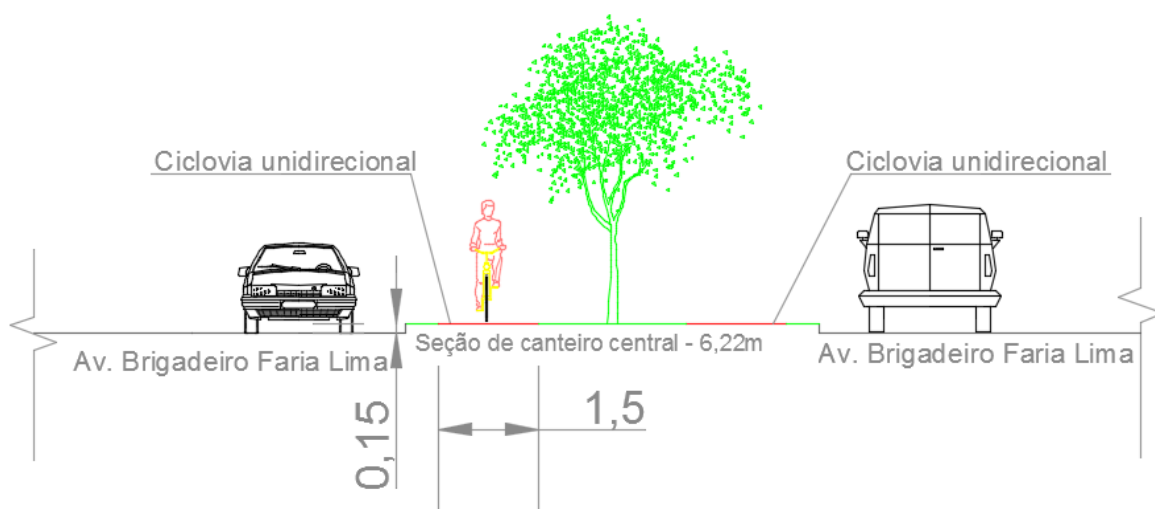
Vista em corte da alternativa que considera o replantio (Fonte: Autoria própria)
